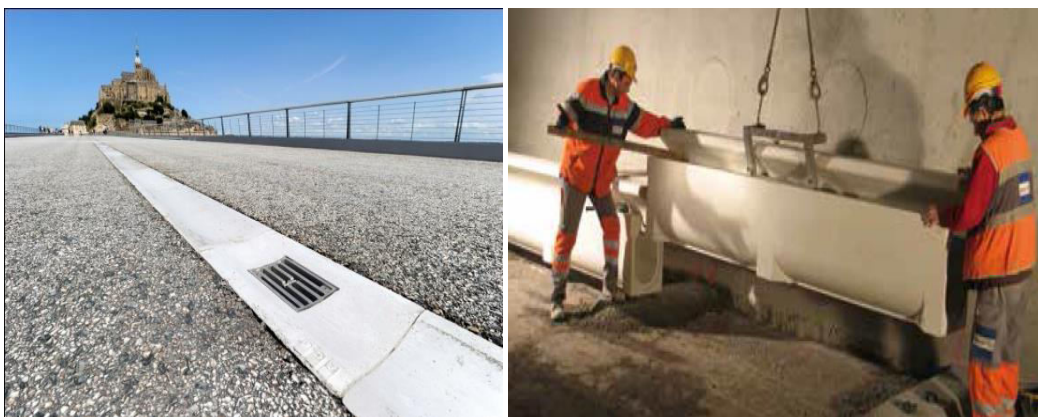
Caniveaux en béton polymère pour le drainage.
